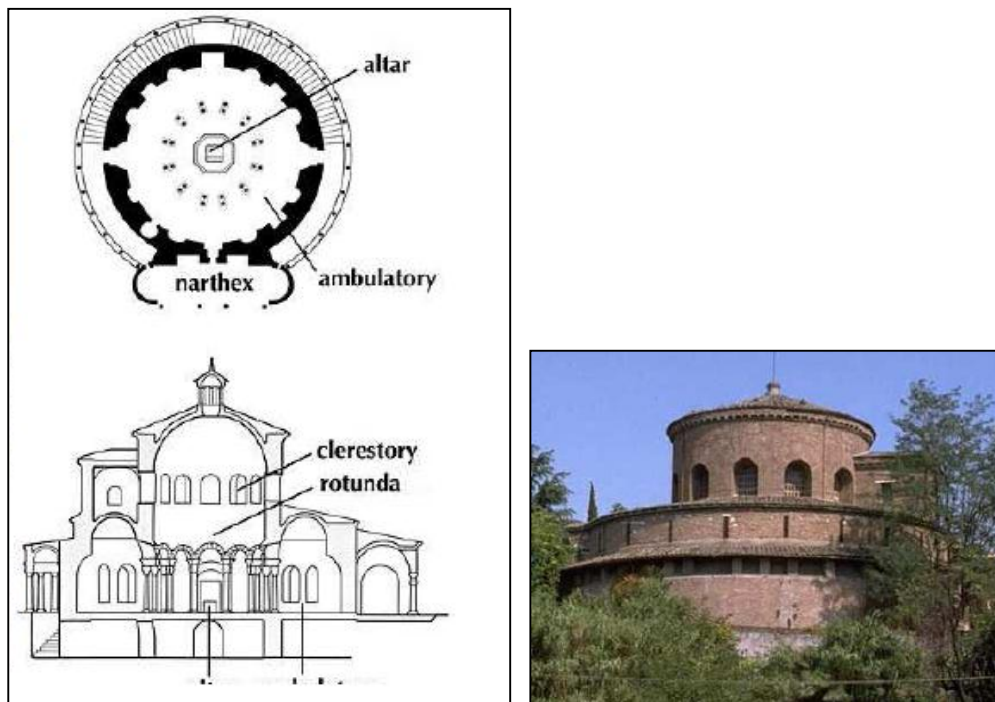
Eglise à plan centré (plan, coupe et élévation). Source : info.univ-tours.fr
